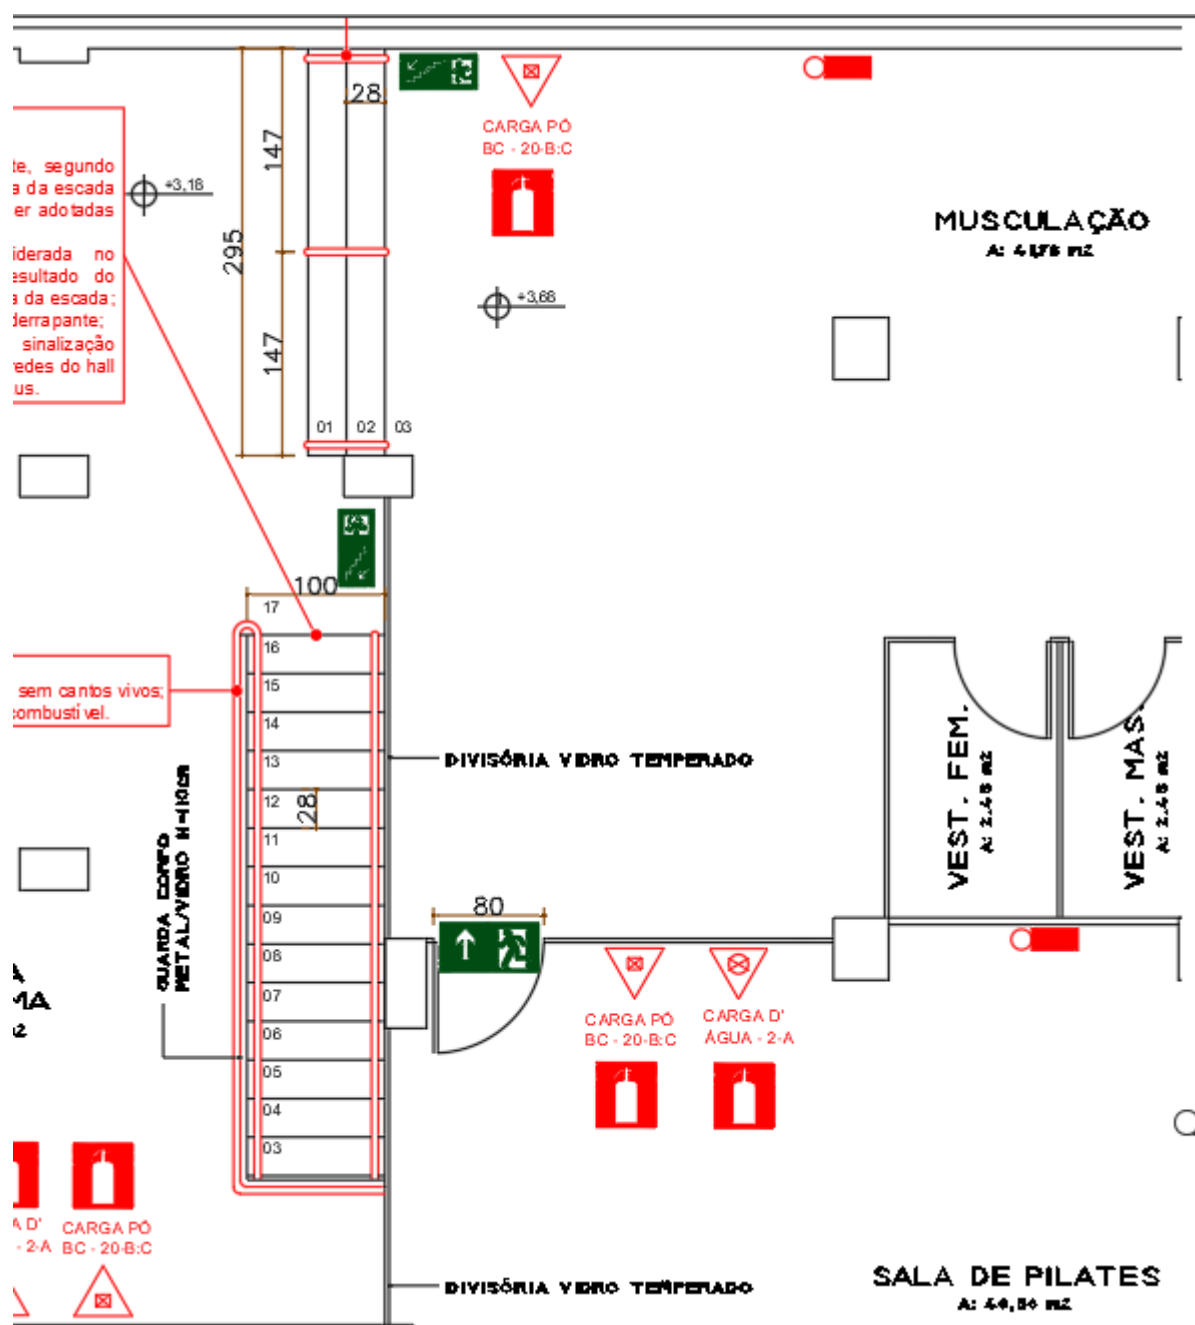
Sinalizações de orientação e salvamento, detalhe localizado no segundo pavimento.
